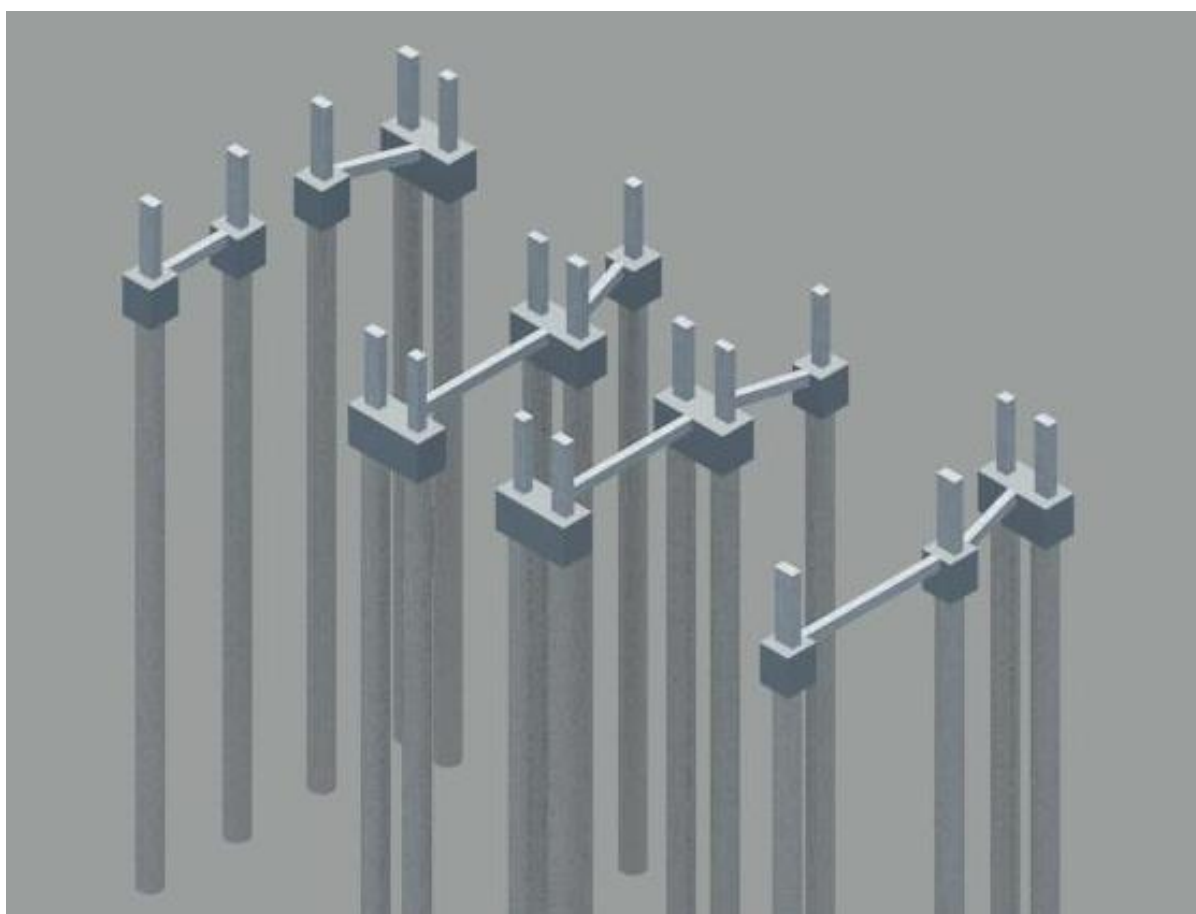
Perspectiva dos blocos de fundação, estacas e vigas-alavanca
